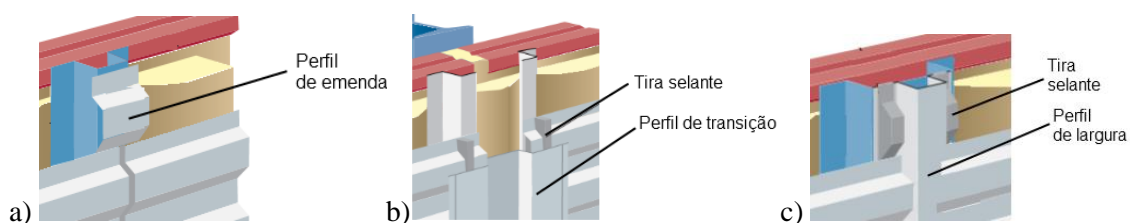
Tipos de juntas verticais: a) Emenda, b) Transição, c) Largura [12].
